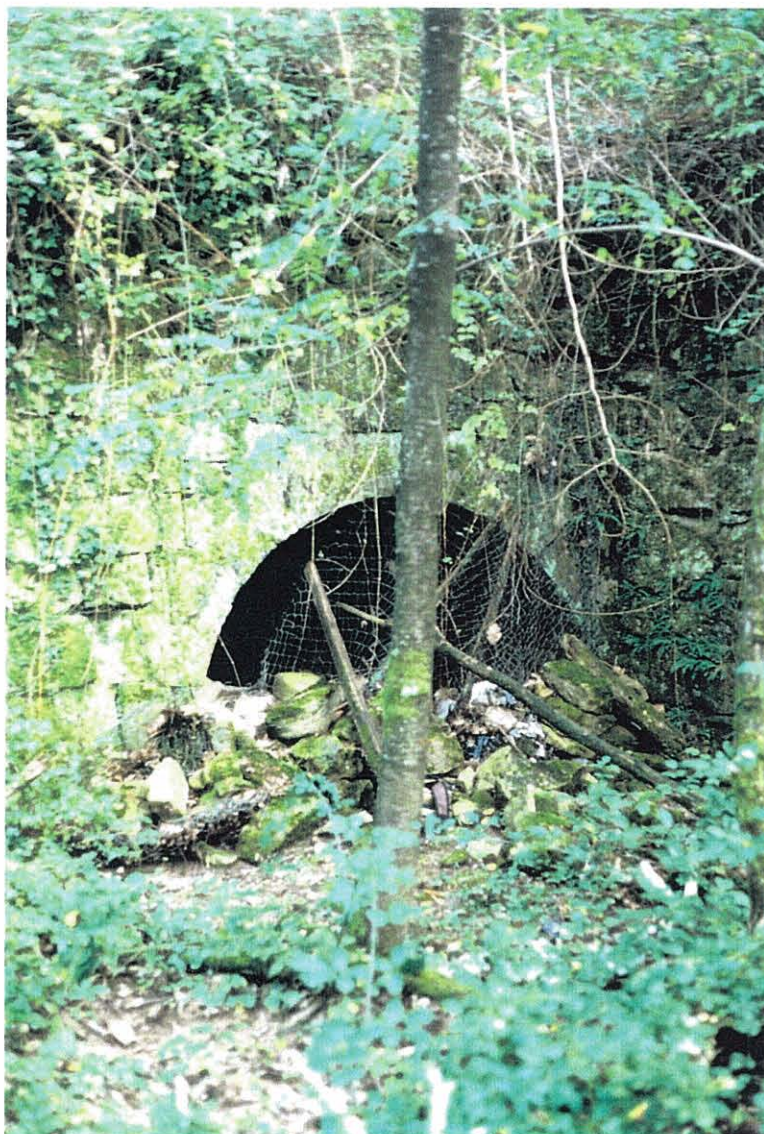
Site 5 : Vue de l'entrée de la galerie incorporé dans un mur en pierre de taille
